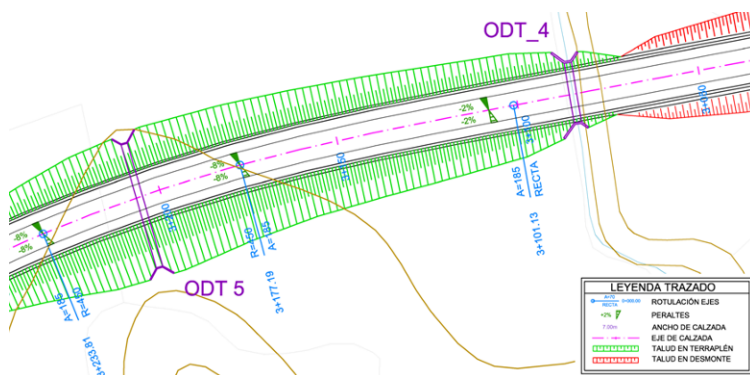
Exemplo de plano en planta coa situación de dúas ODTs
